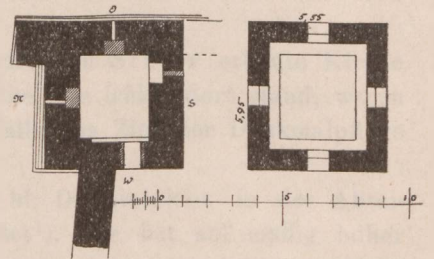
Grundrisse des Turmes zu Gollub. Maßstab 1 : 300.
